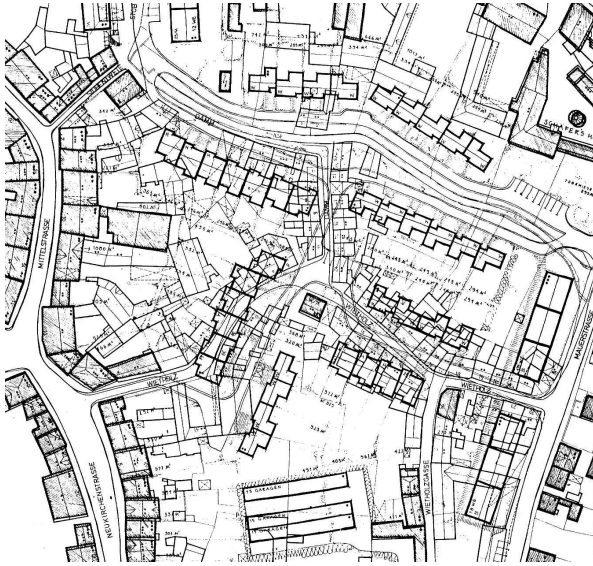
Osterwieck. Ausschnitt eines Plans zur tiefgreifenden Umgestaltung der Straßen Wietholz und Damm (1977).
